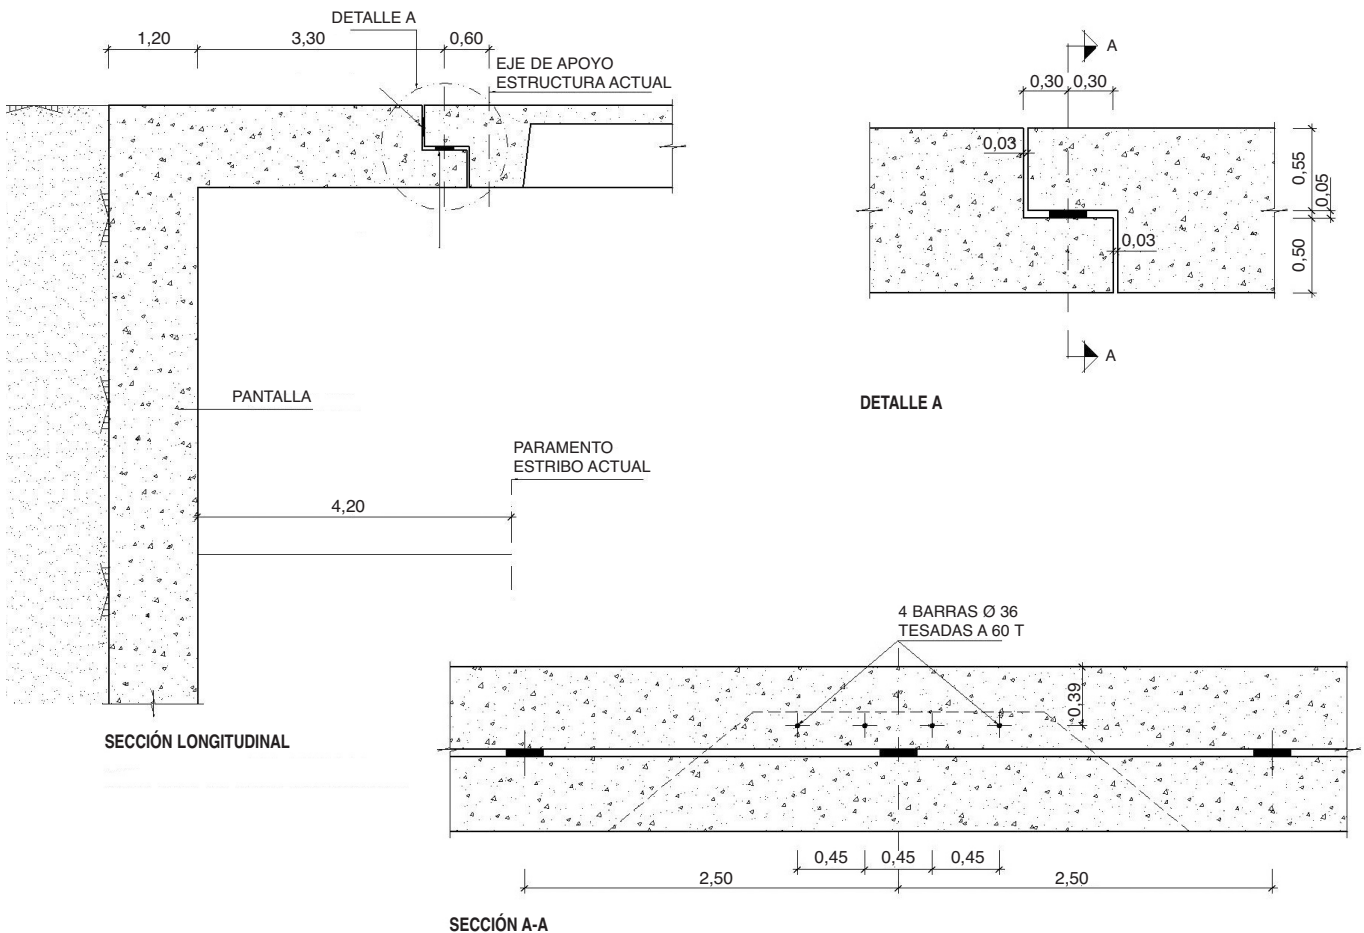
Detalle estudio ampliación de la estructura con apoyo a media madera.
